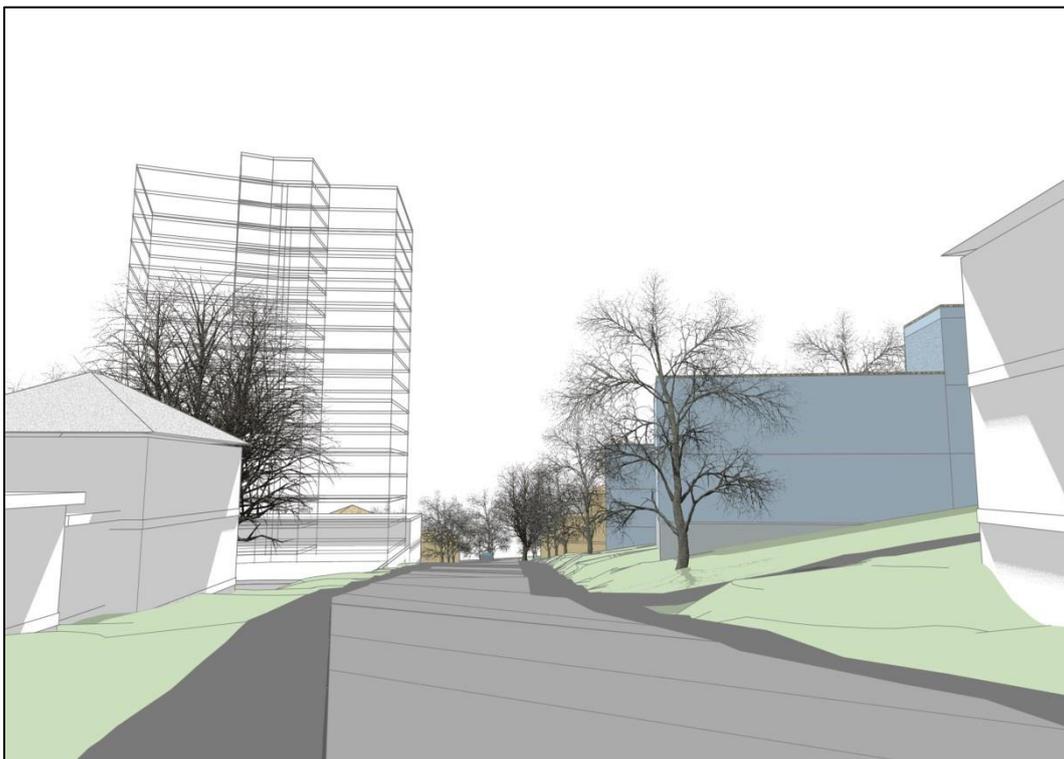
Waldstraße aus Richtung Nordost (rechts angeschnitten Haus Waldstr. 9)
